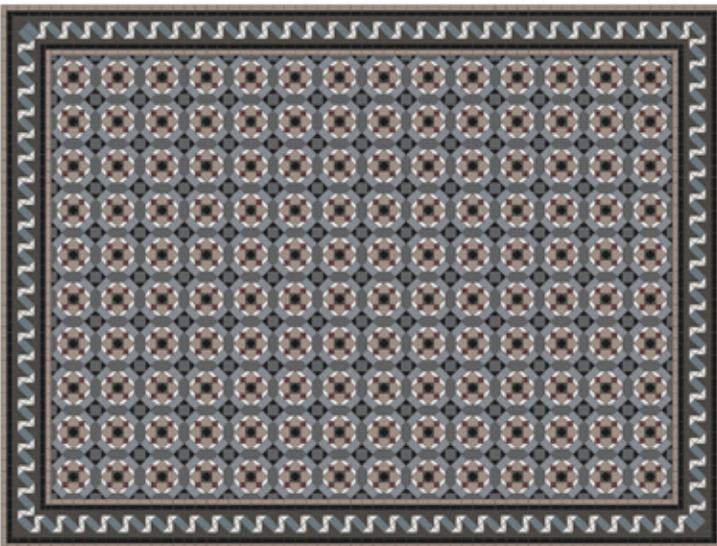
Villa Morris. Pavimento de cerámica Nolla del despacho en planta baja. Fuente: Autores.
